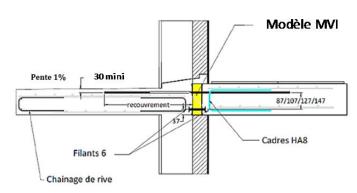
Coupe plancher béton armé/balcon (Rupteur MVI) (le doublage est réalisée selon les prescriptions de l'Annexe 9)
